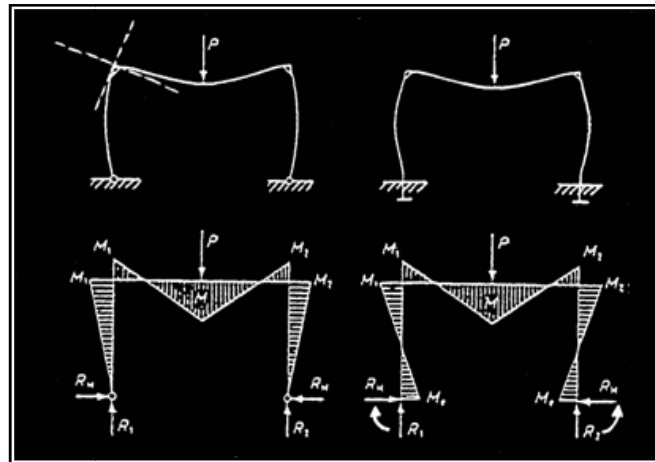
Vigas y columnas no infinitamente rígidas.
